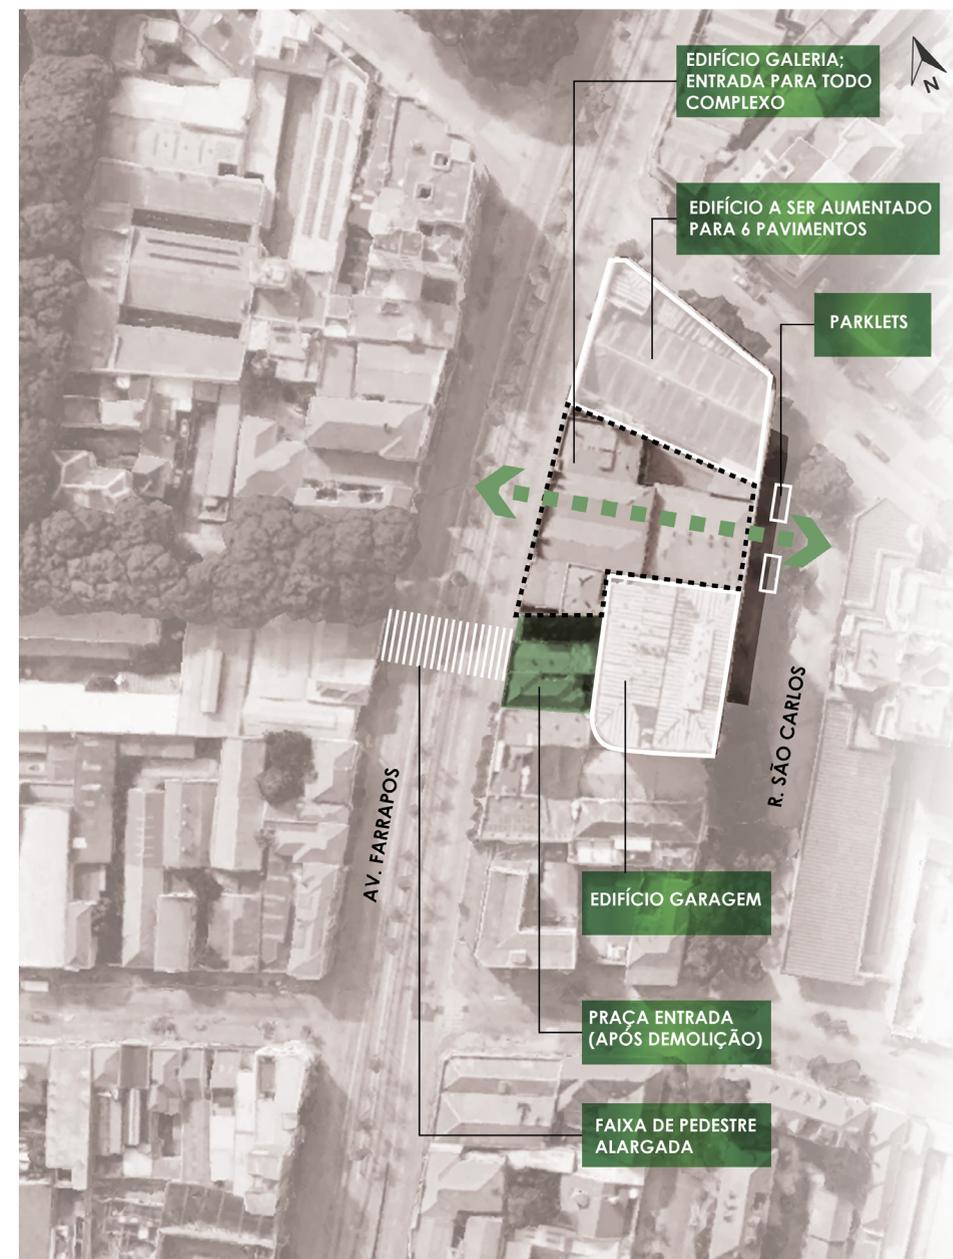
Planta baixa esquemática da proposta para a edificação da Importadora Americana.
